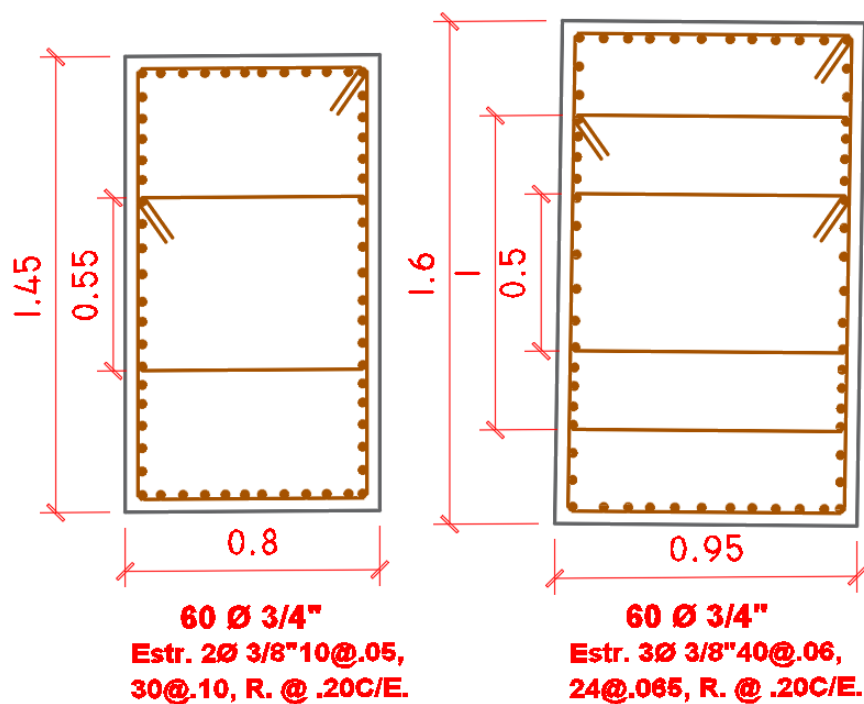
Detalle del acero de refuerzo de la sección de las columnas empleadas en el sistema semi-colgante.
